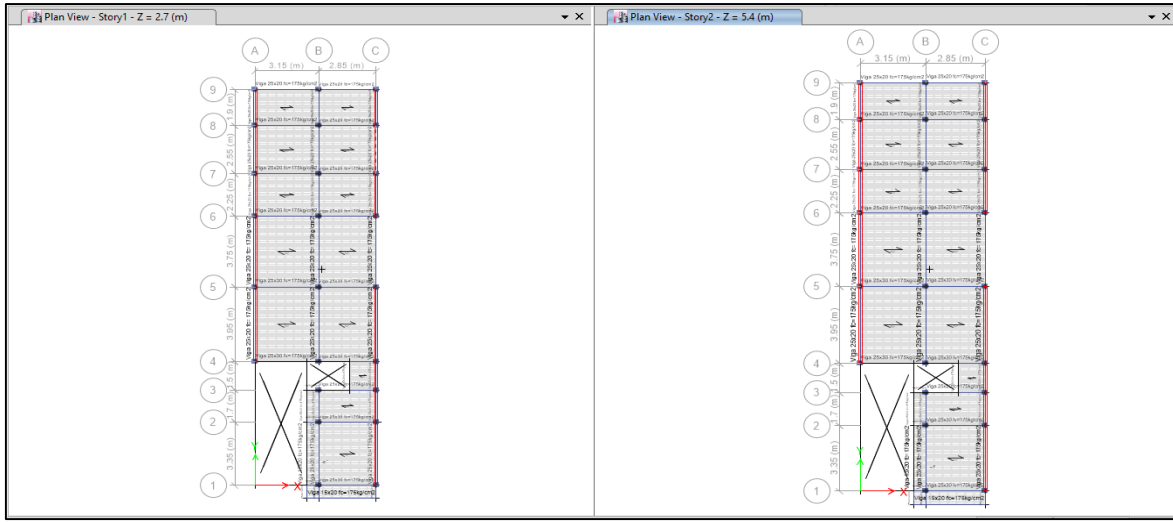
Vista en planta de la situación actual de la vivienda 2 – 1er y 2do Nivel. Fuente: propia.
